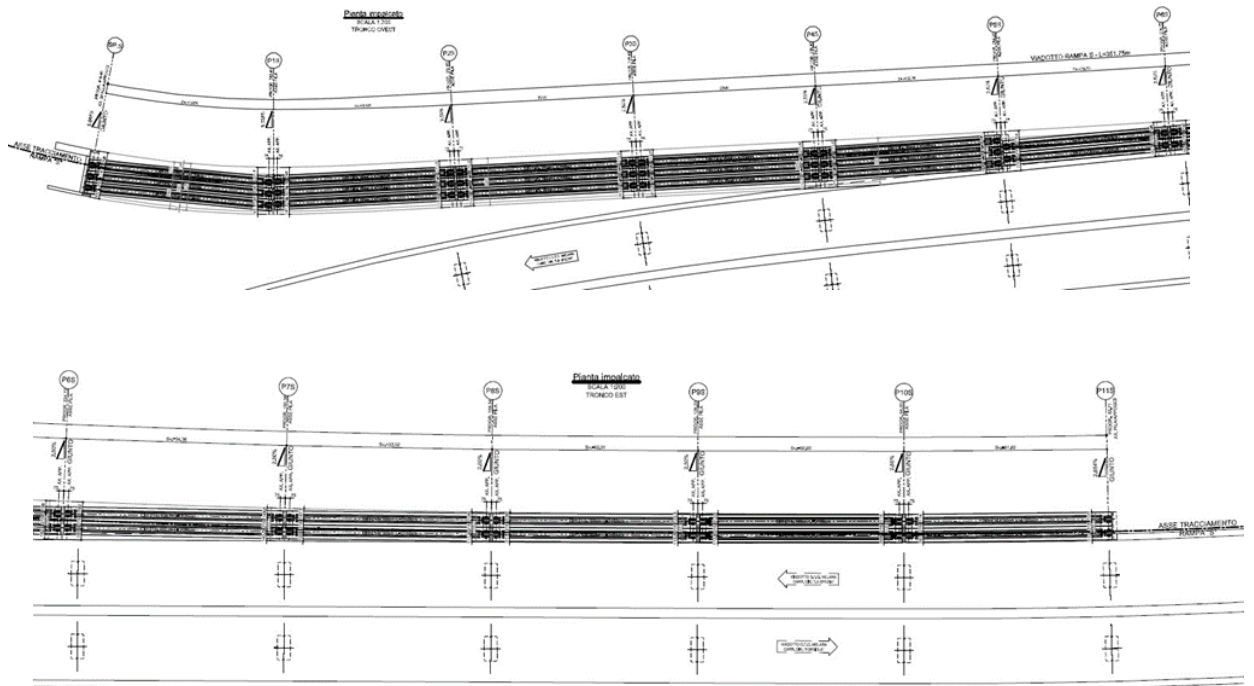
Planimetria Rampa S svincolo Melara
